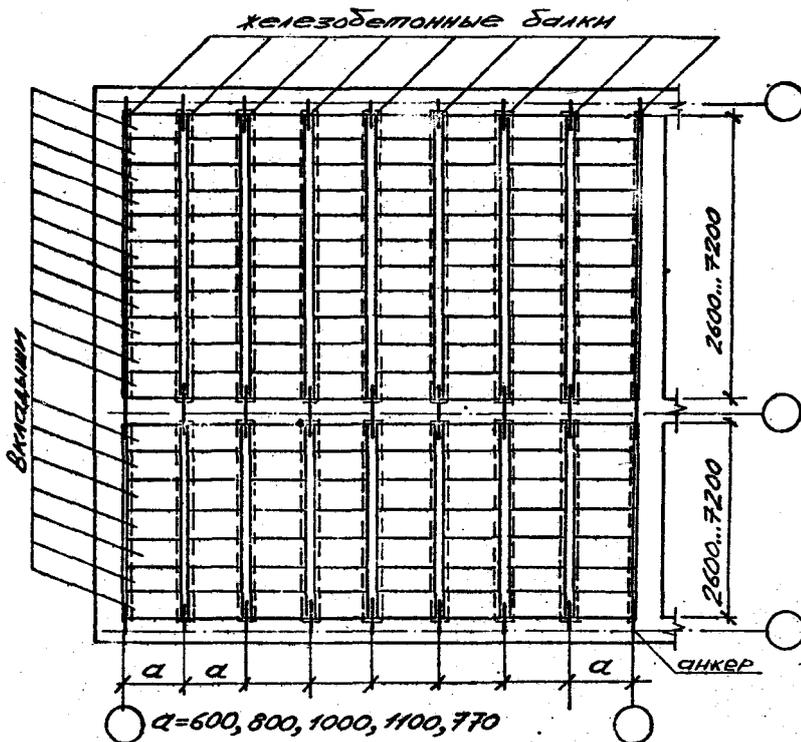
Фрагмент плана перекрытия по железобетонным балкам
